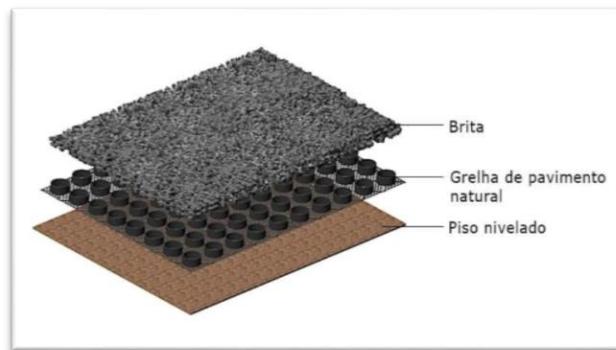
Demonstração de instalação de ecopavimento de brita, fonte: Ecotelhado
